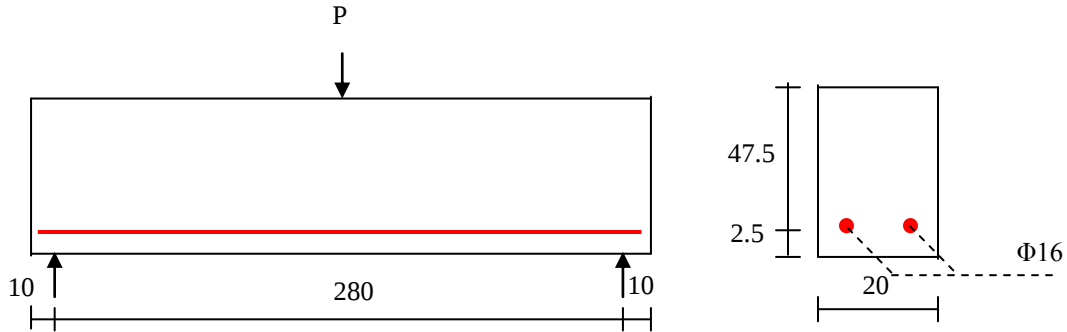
Géométrie, chargement et renforcement de la poutre (Dimensions in cm)
